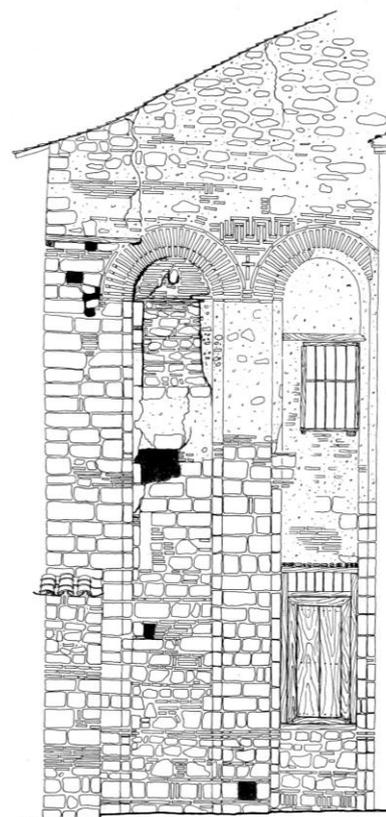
Alzado norte de la torre norte antes de la restauración.
